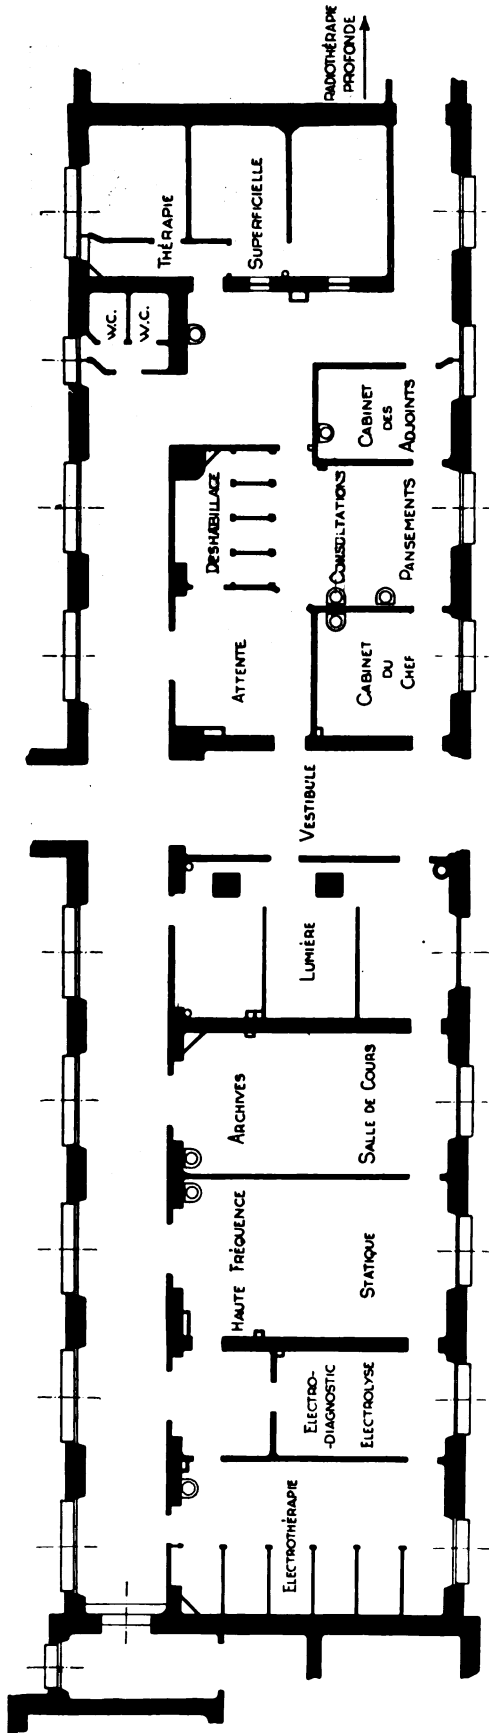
Plan du Service de Thérapie. La Radiothérapie profonde est à droite. (Voir le plan ci-dessous.)
